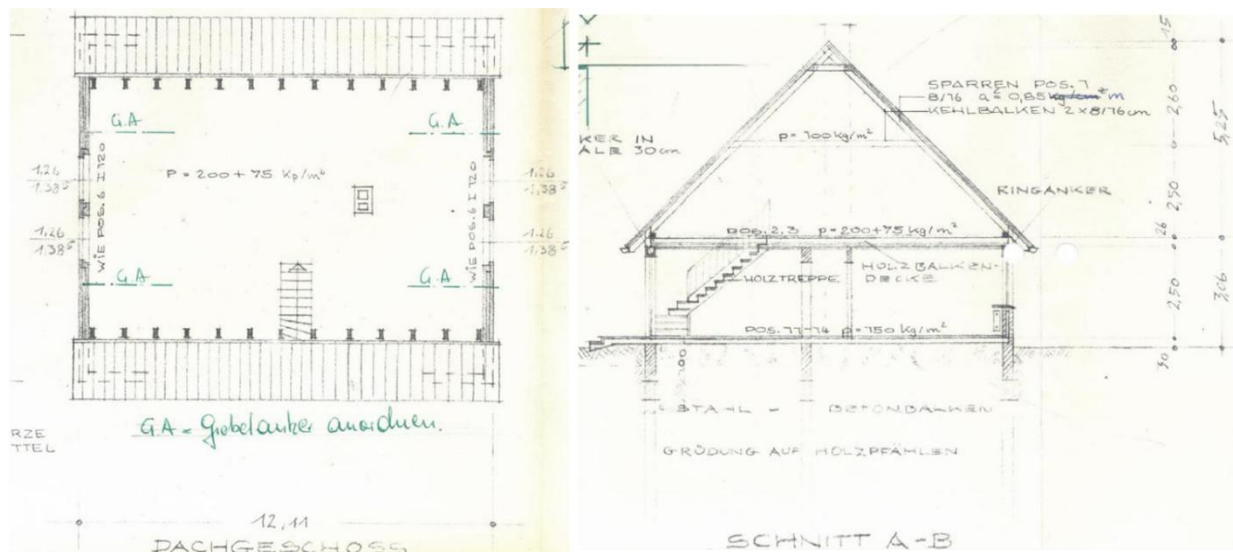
Grundriss Dachgeschoss und Gebäudeschnitt – ohne Maßstab
